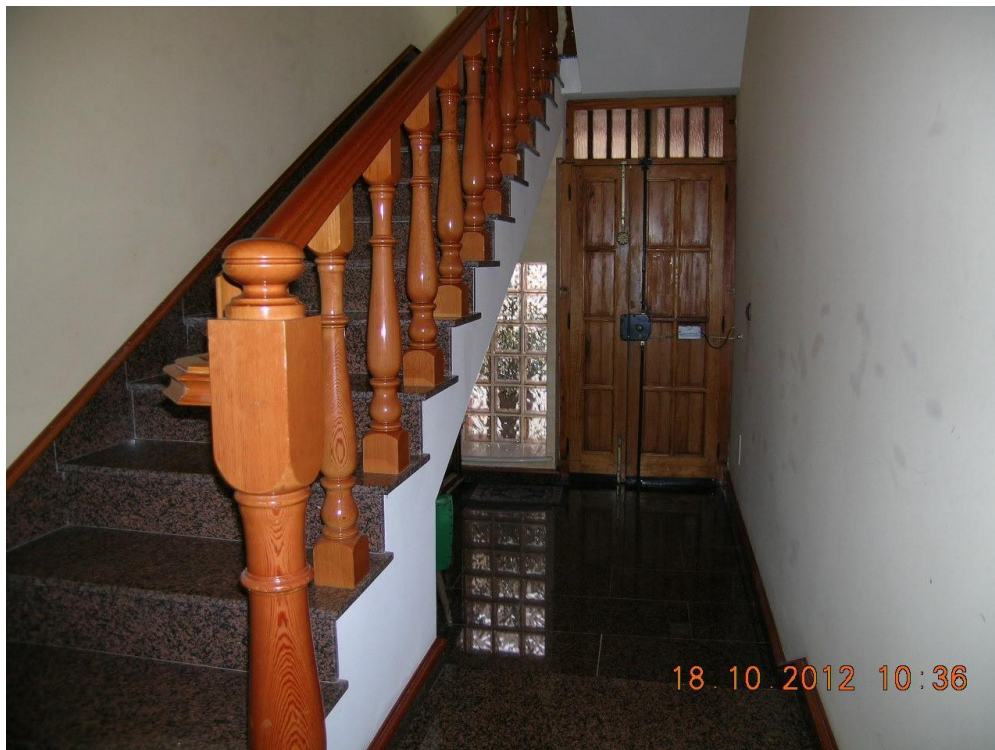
/30: L'ingresso dell'abitazione visto dal vano scala.
